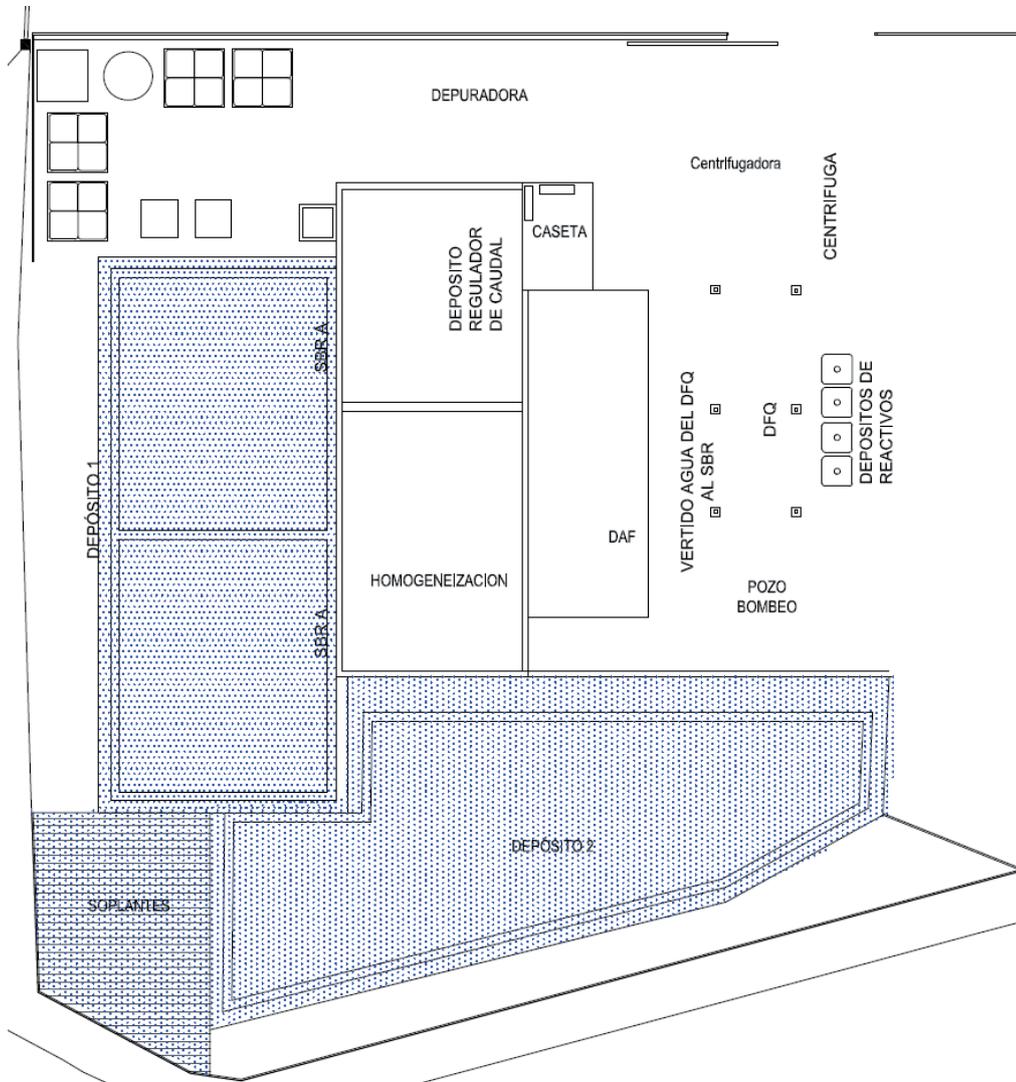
Plano en planta de la instalación, en el que se resaltan las zonas en las que se llevarían a cabo modificaciones
